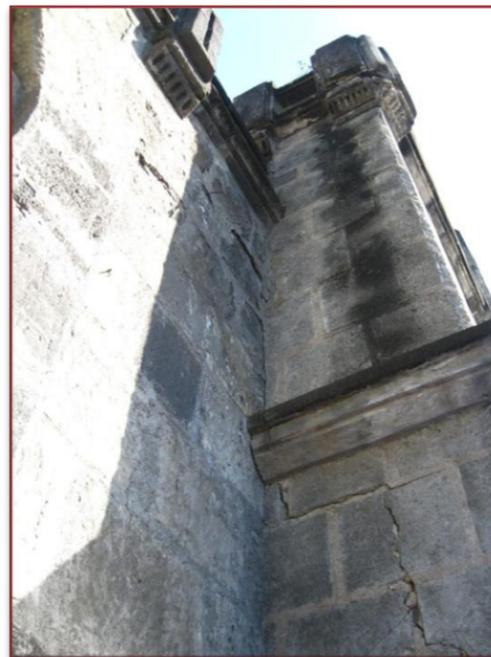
Grieta en la intersección de la torre Norte con el muro Oeste. Nótese como los esfuerzos han fracturado la piedra Fuente: José L. Mendoza.
